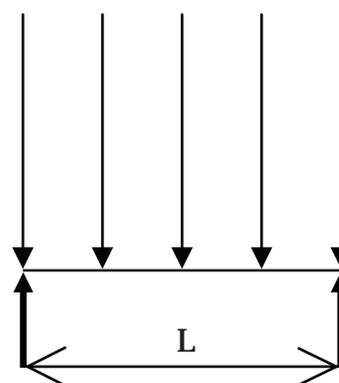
, Таблица 4. Нагрузки на кровельные панели с минераловатным утеплителем при схеме нагружения — статически определяемая однопролетная балка.
